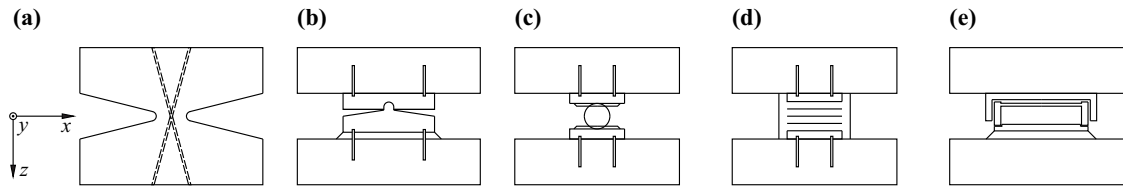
Lagerbauformen: (a) Betongelenk; (b) Stahl-Linienlager; (c) Stahl-Rollenlager; (d) Gummi-Schichtlager; (e) Neotopf-Gleitlager.
